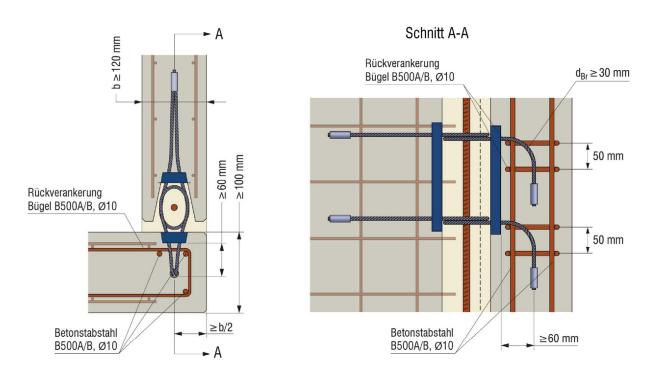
Wand – Wand – Eckverbindung - Detail mit abgewinkelten Seilschlaufen
